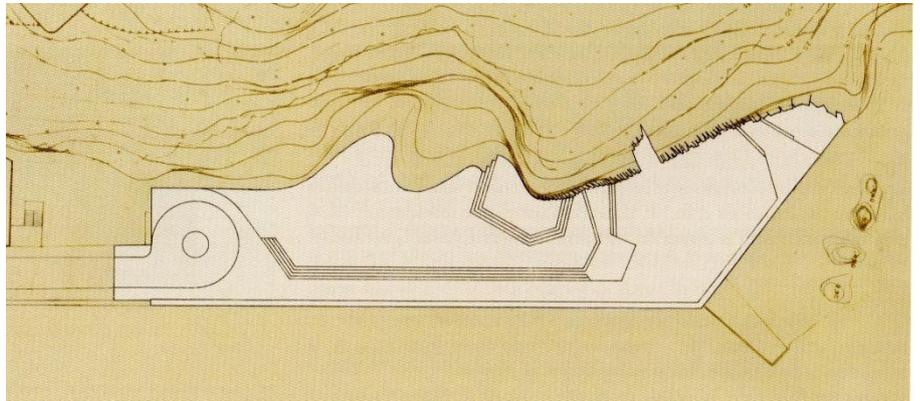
Proyecto inicial de pavimentación planteado por Peña Ganchegui.
